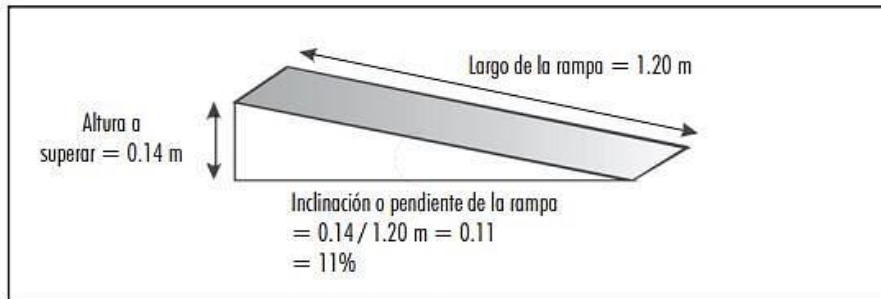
Cálculo de la pendiente o inclinación de la rampa.
